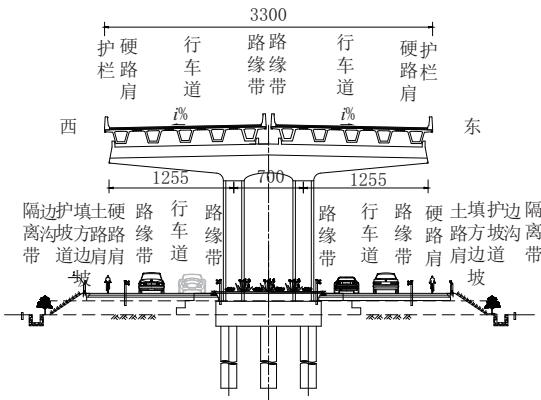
横断面布置图(俞汇互通—魏俞公路段)(单位:mm)
